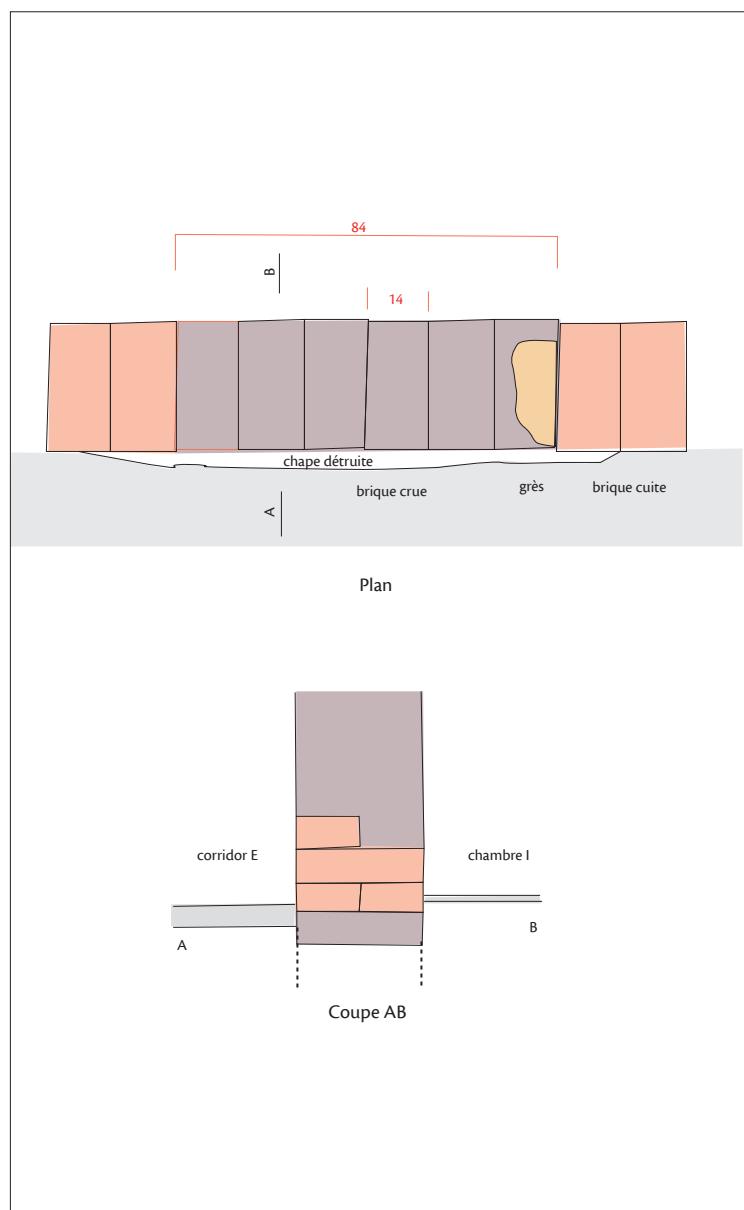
Plan et coupe du seuil de la porte de la chambre I, détail.
